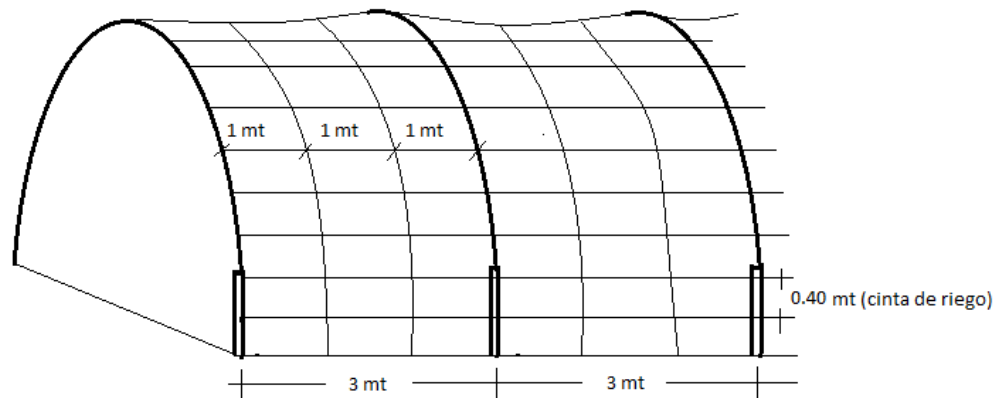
Medidas en como quedo el agril para cubrir el macrotúnel.
